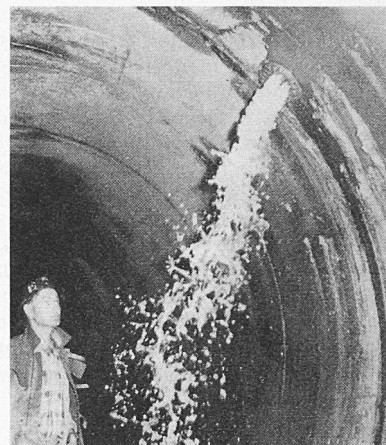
(rechts). Mit Kugelventil gefasste Quelle
